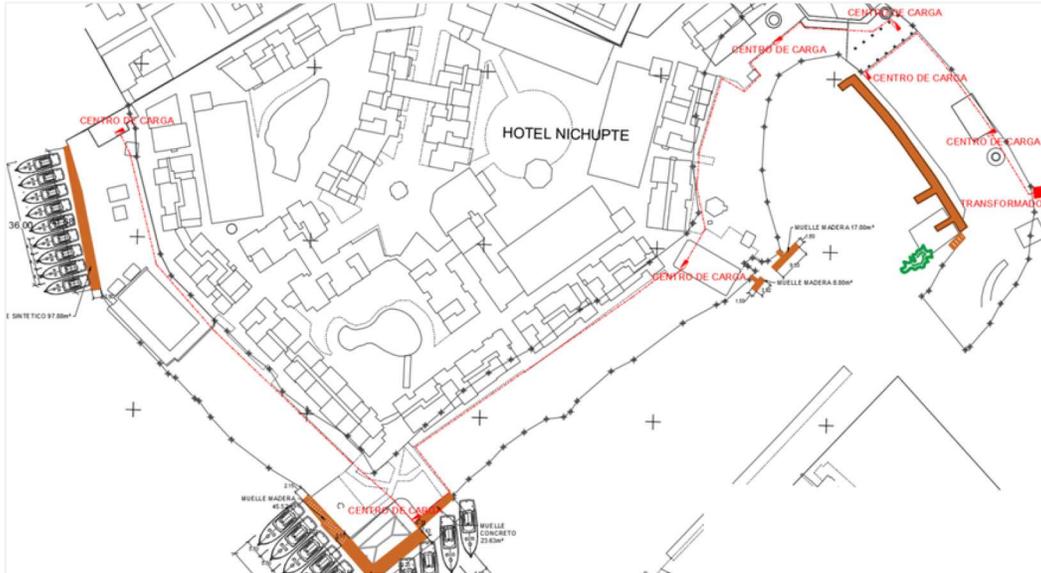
Plano de conjunto de las instalaciones eléctricas.
